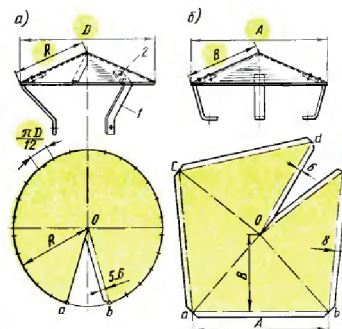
Заготовки зонтов: а — конического; б — пирамидального; 1 — стойка, 2 — заклепка
